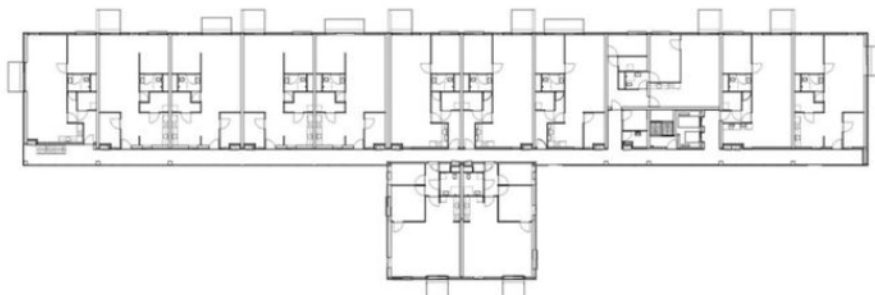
Planta Piso 4 dos apartamentos WoZoCo's
